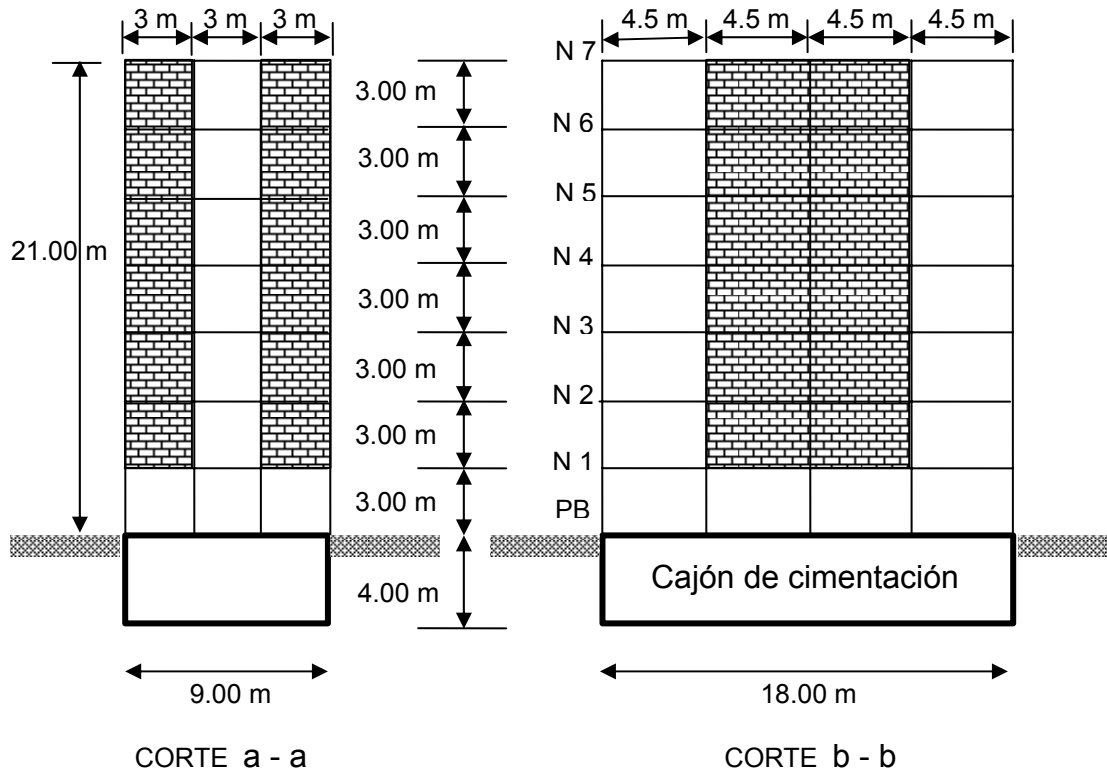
Vistas en elevación de la estructura de 7 niveles
